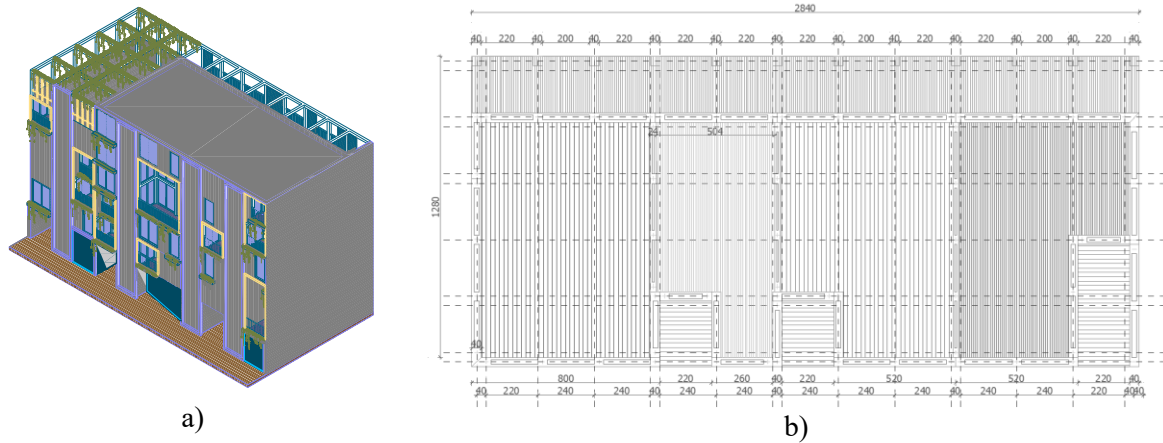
Caso de estudo: a) vista 3D; e b) planta do piso tipo (unidades em centímetros).
